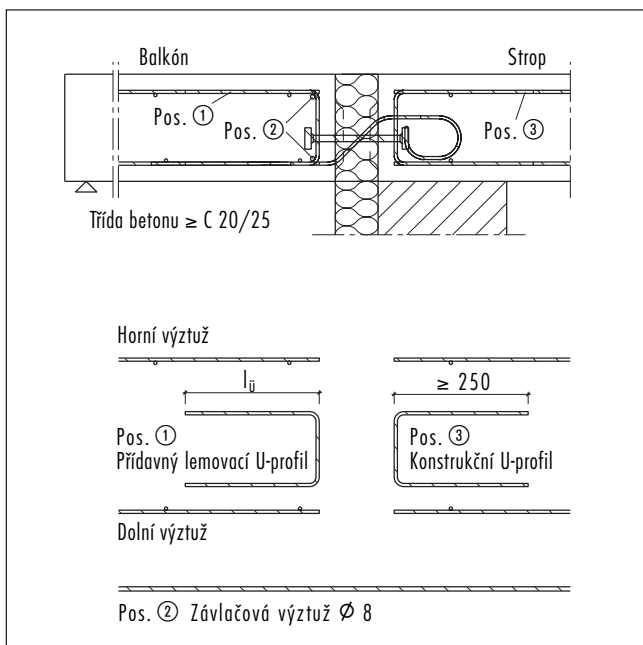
Zabudování s Schöck Isokorb® Typ Q 8/6, d = 16 cm
